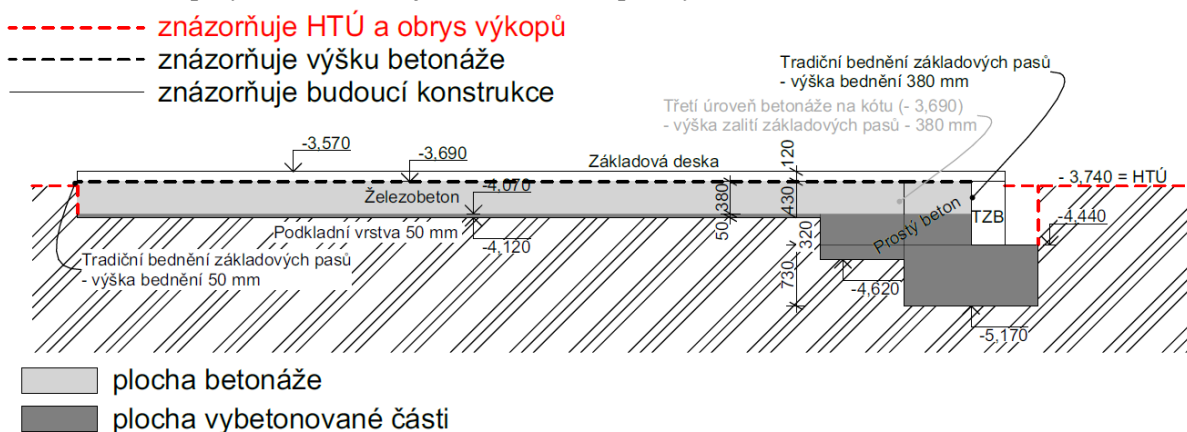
Druhá úroveň betonáže základových pasů
